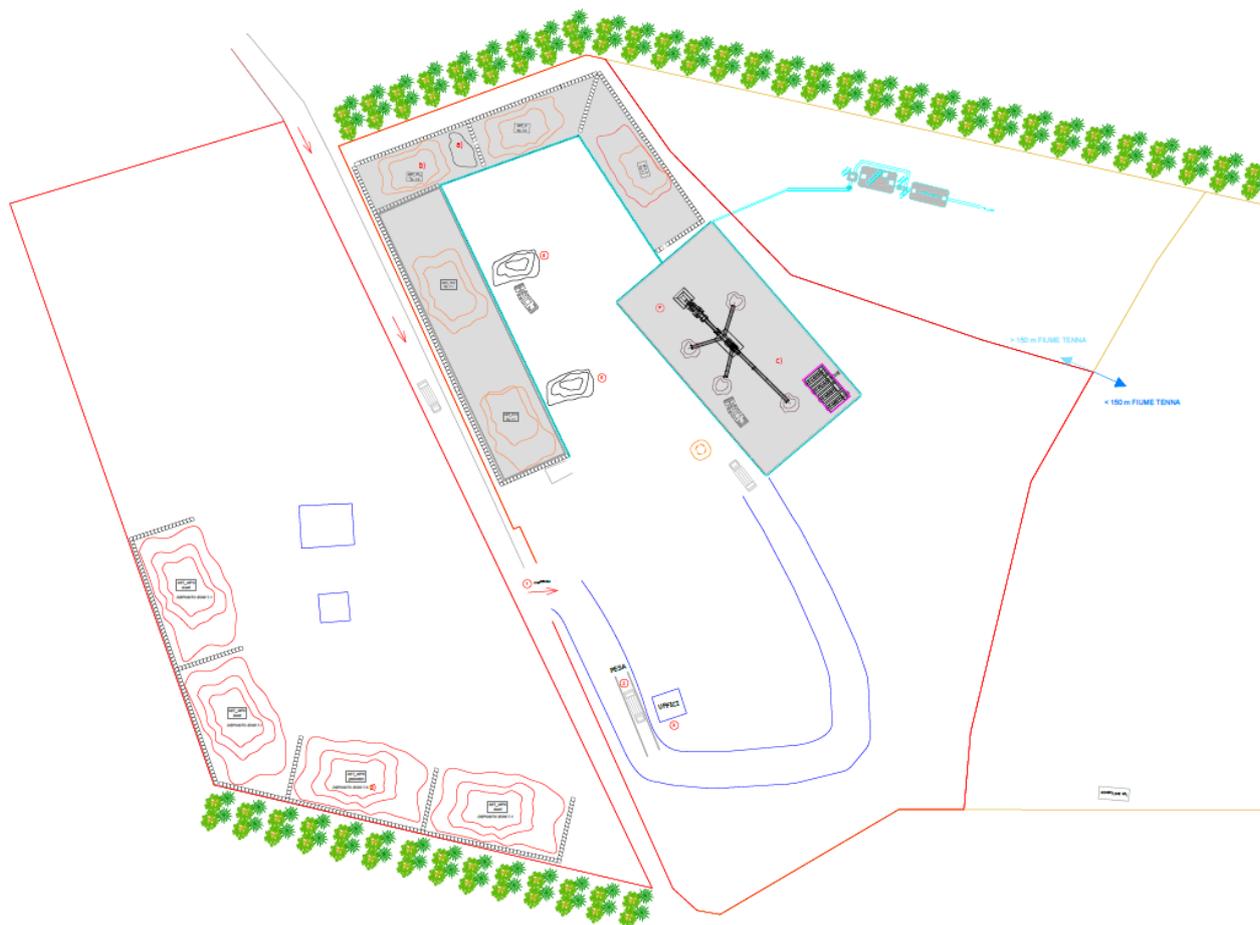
Planimetria generale stato di progetto - impianto con legenda.
